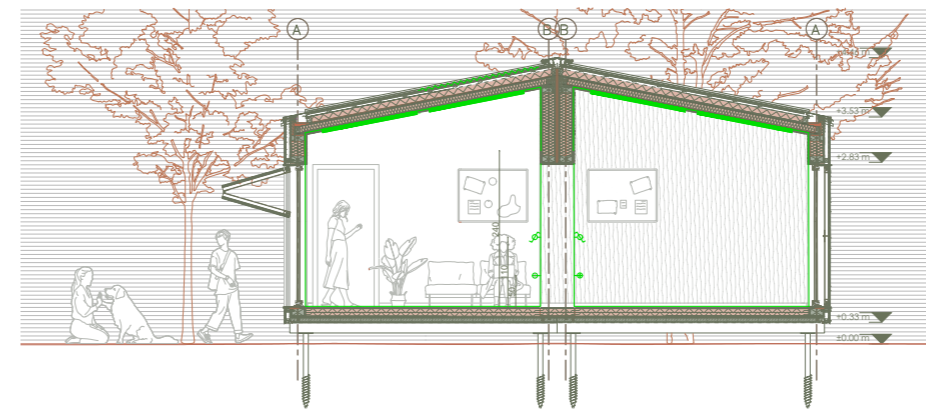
Sezione e pianta distribuzione sistema elettrico
